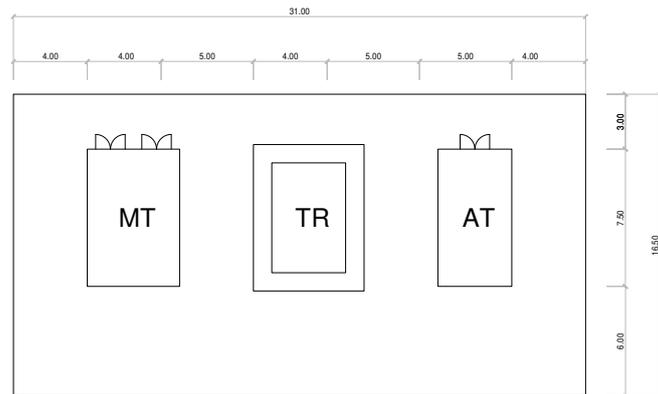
Platea di fondazione dell'area di trasformazione e disposizione cabine/componenti.
